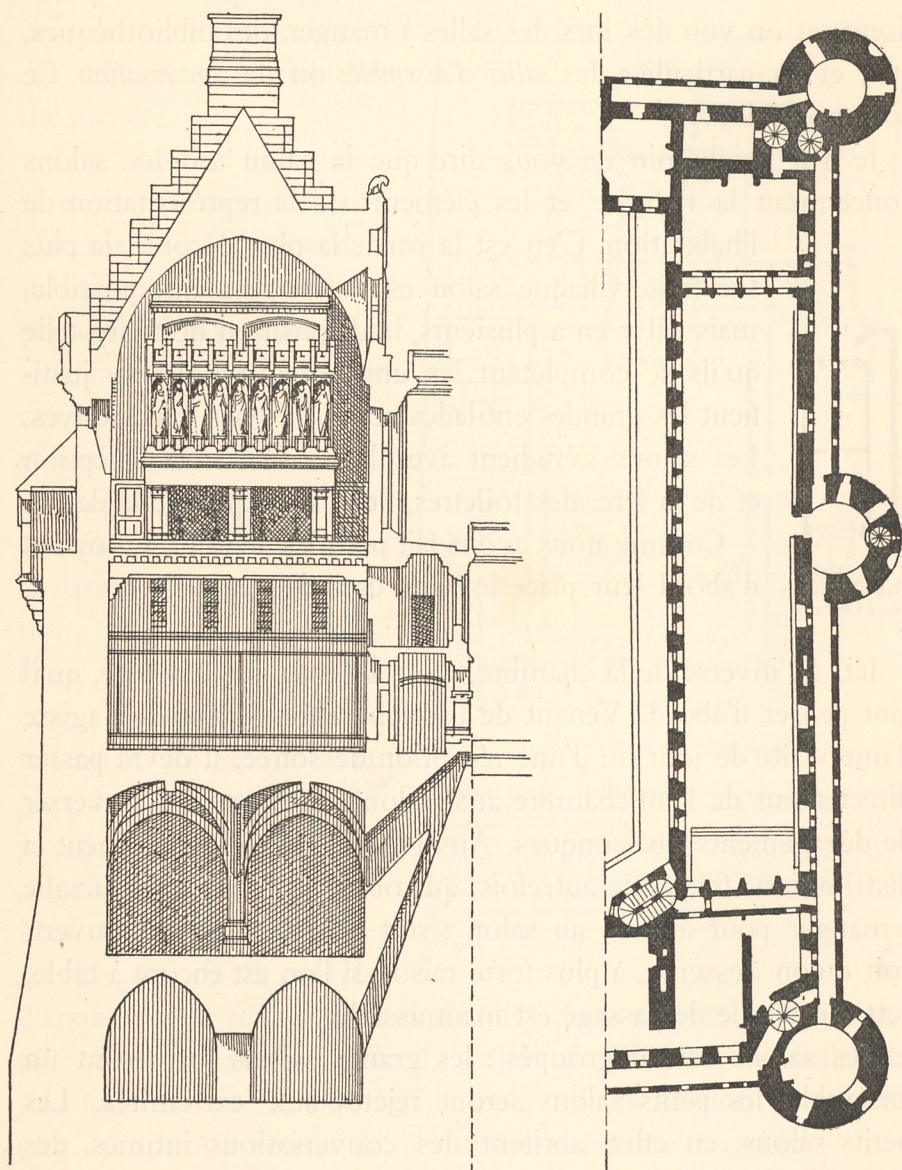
Grande salle du château de Pierrefonds. Coupe et plan.
